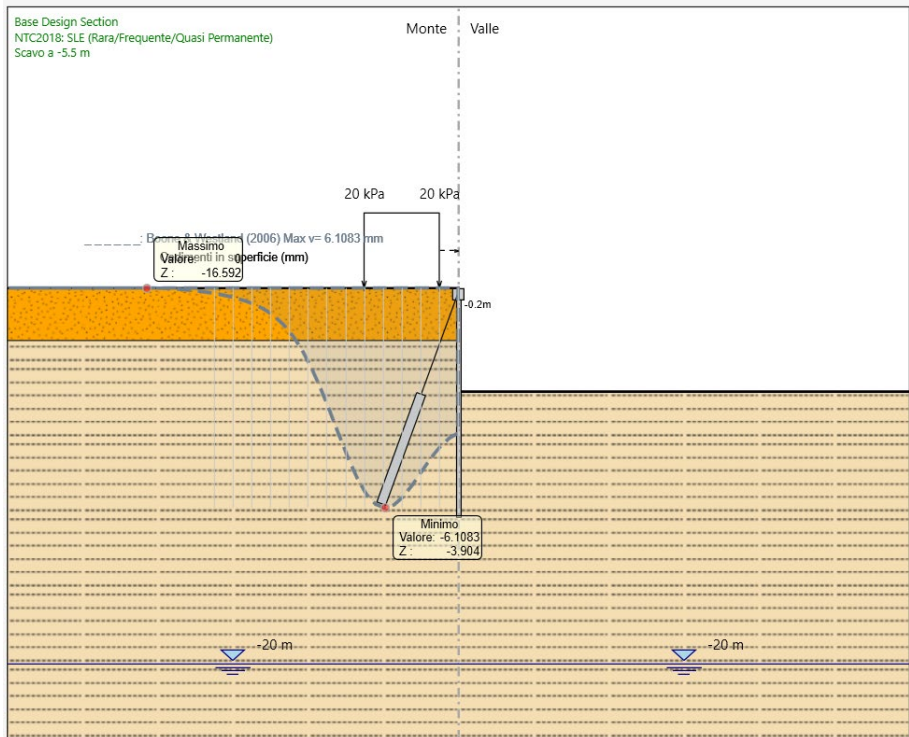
Sezione Tipo B1 – Spostamenti stima cedimenti
